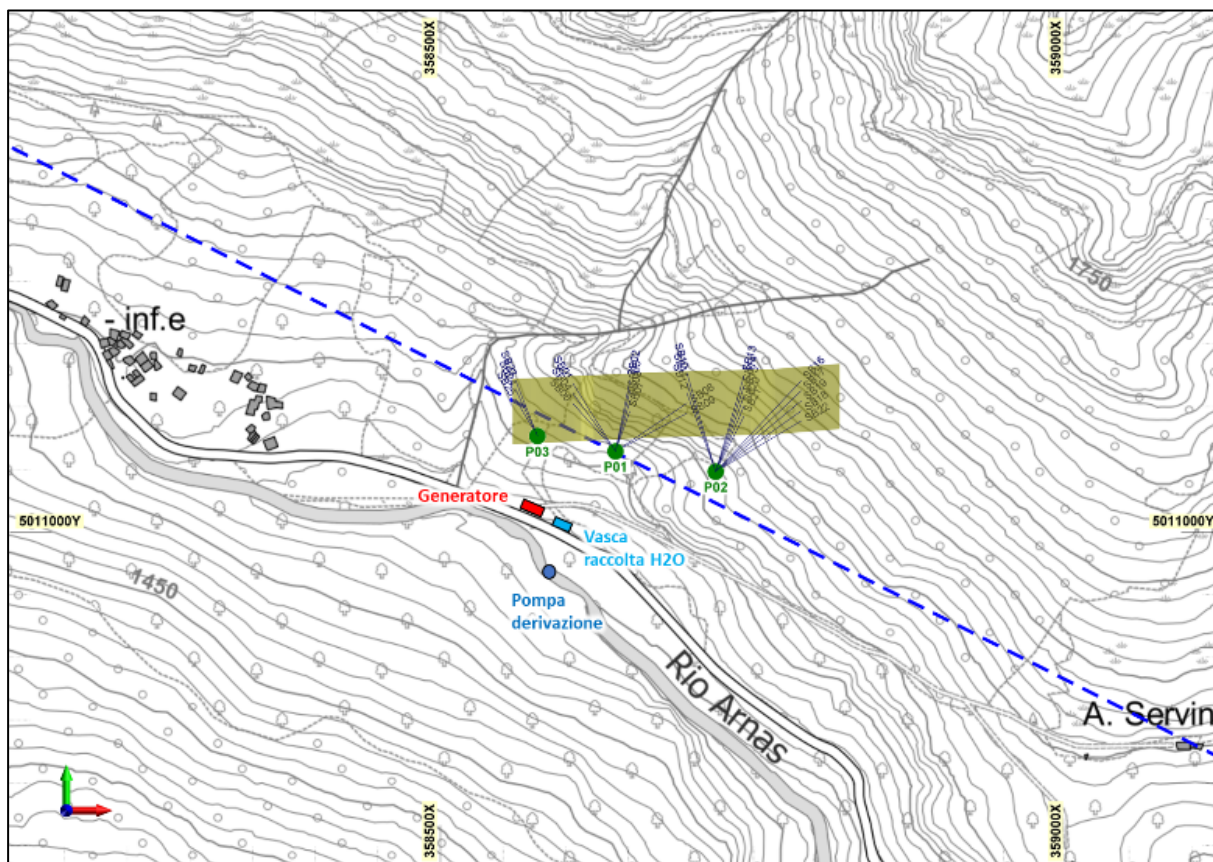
Ubicazione generale di cantiere con individuazione delle tre piazzole di lavoro.
